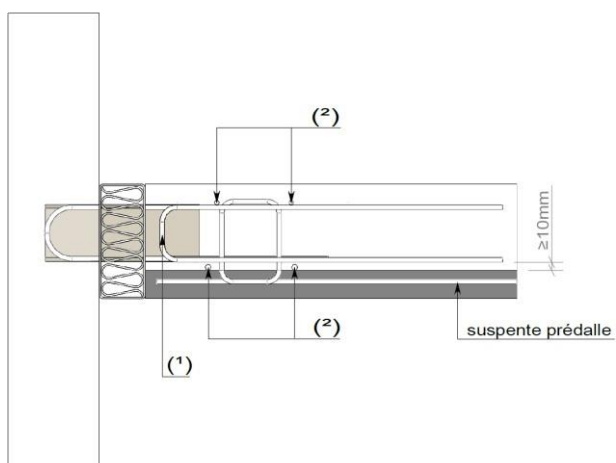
Chainage en rive de plancher – liaison dalle-façade – disposition 1 (vue en coupe)
